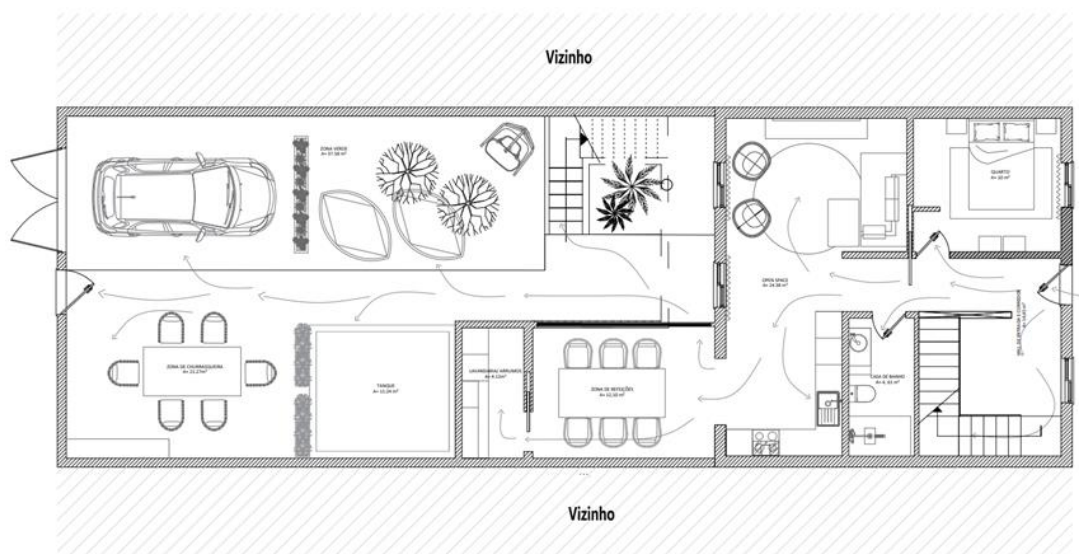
Plantas de Circulação e Zonamentos PISO 1/ Sótão, Fonte: Autor
